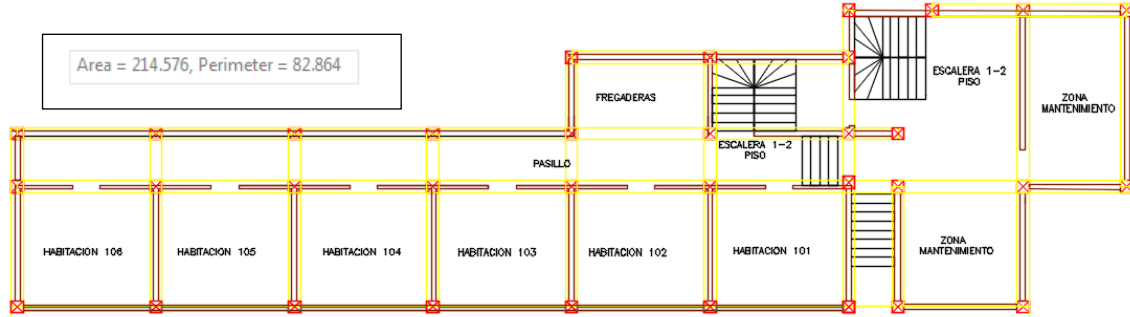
Dibujo AutoCAD vista planta (Planta baja)
